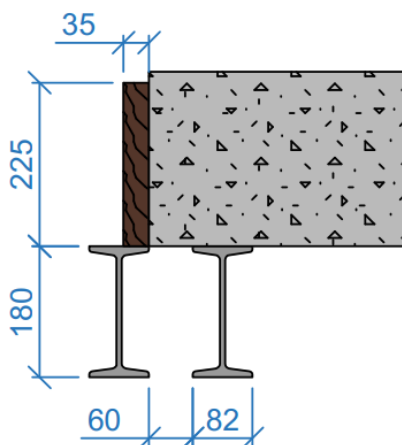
Coupe de la poutre de l'ancienne trémie (7)
